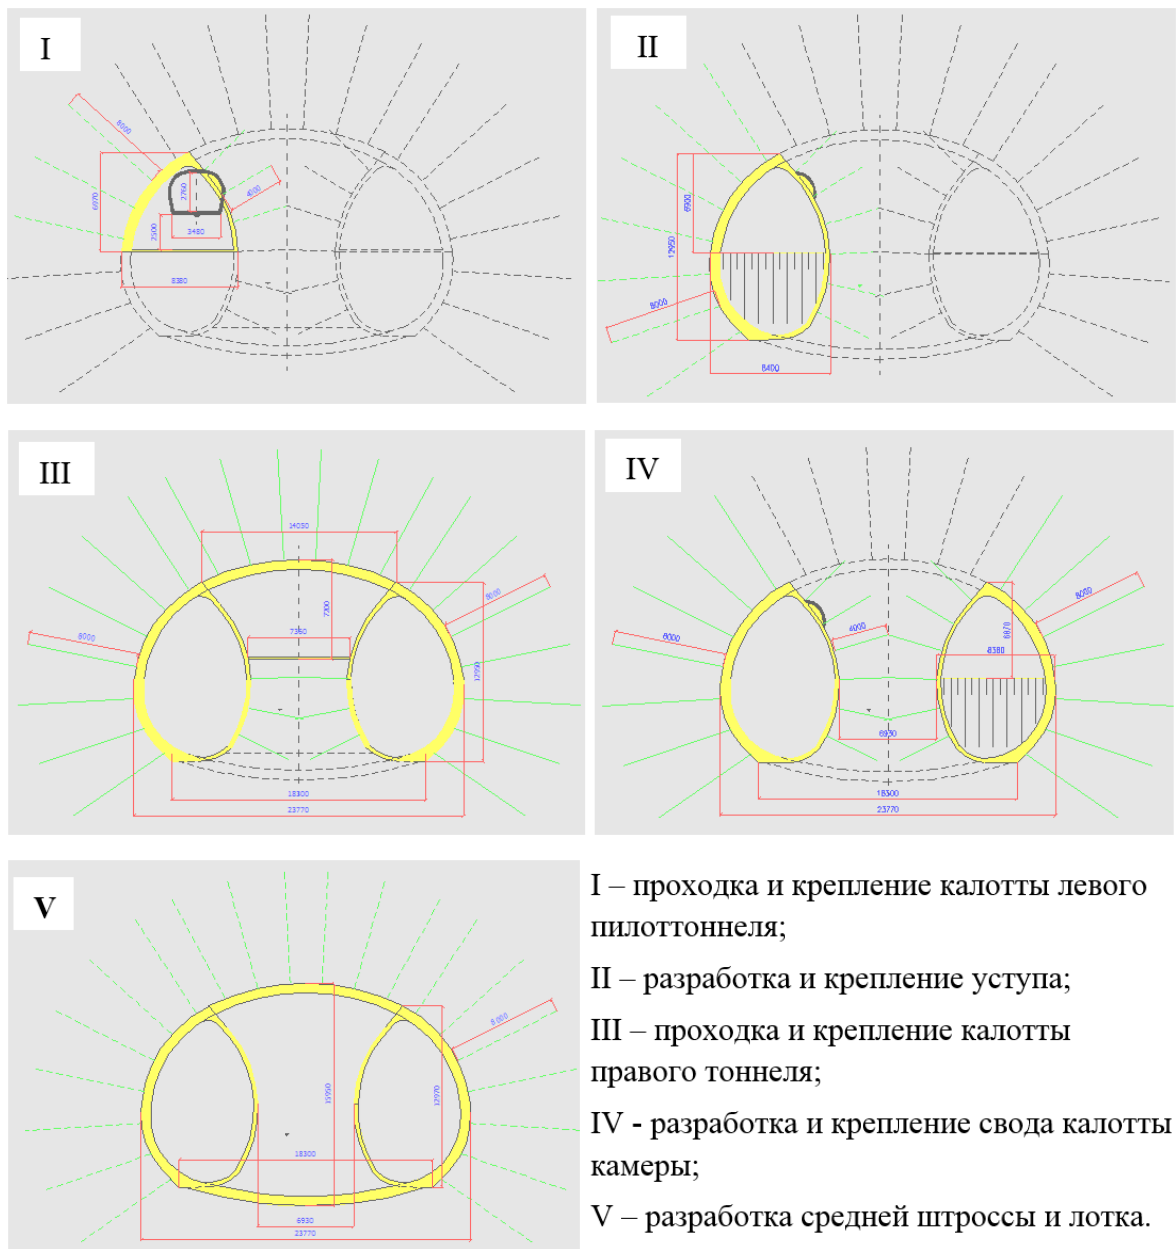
Этапы раскрытия выработки автодорожного тоннеля
